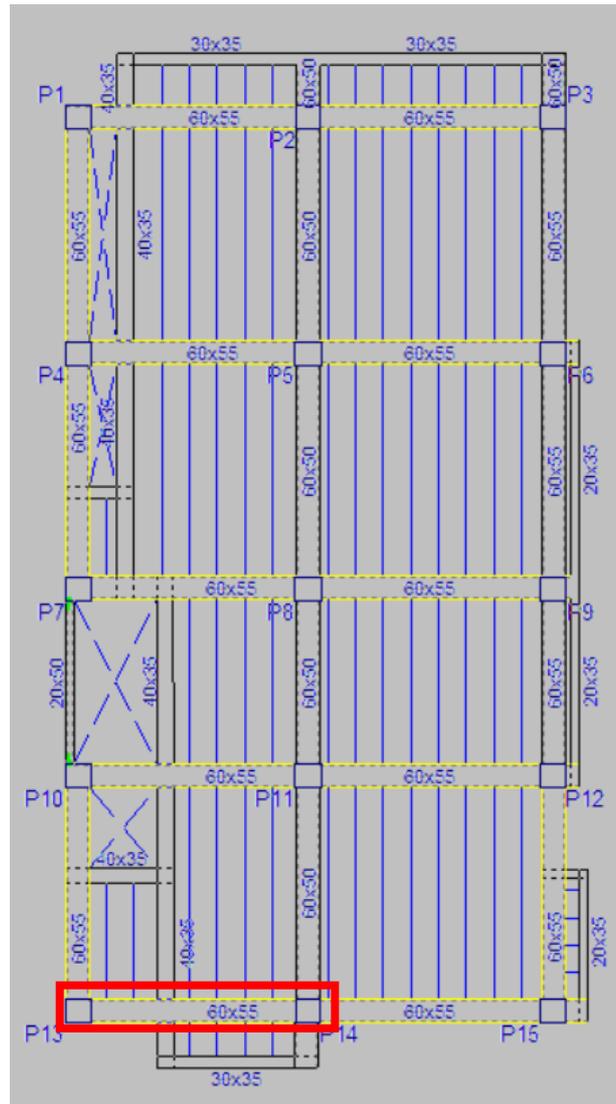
UBICACIÓN VIGA P13-P14.
